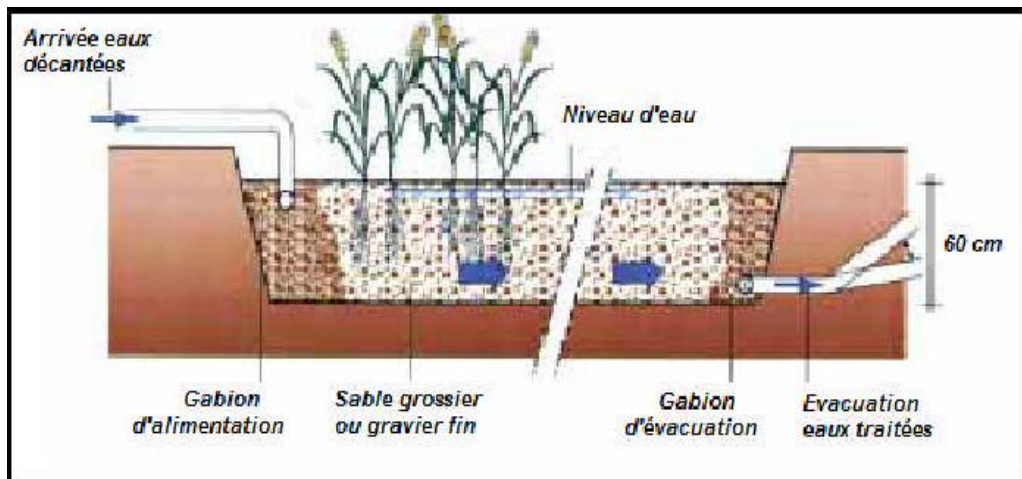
Coupe transversale d'un filtre planté à écoulement horizontal
